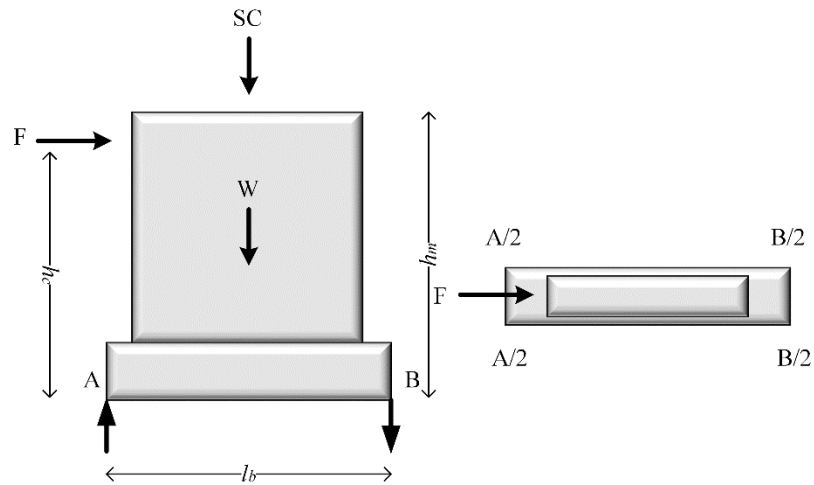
Vista frontal y en planta del muro ensayado y distribución de esfuerzo en la losa de reacción.
